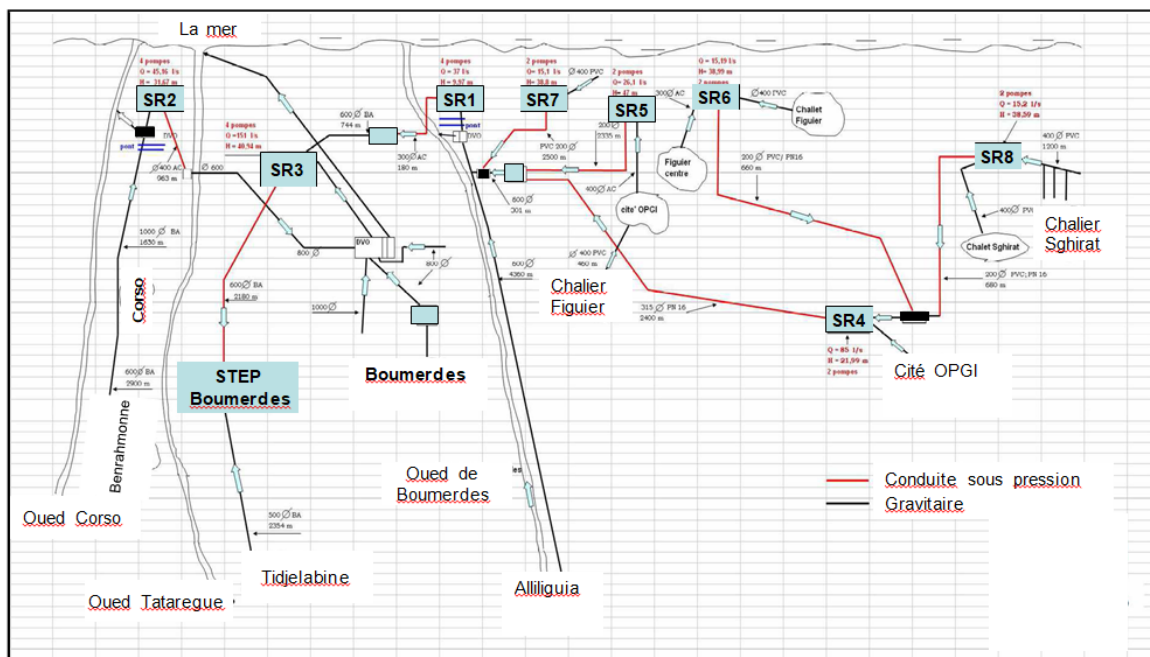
Le système de conduit d'assainissement vers la STEP de Boumerdès.
